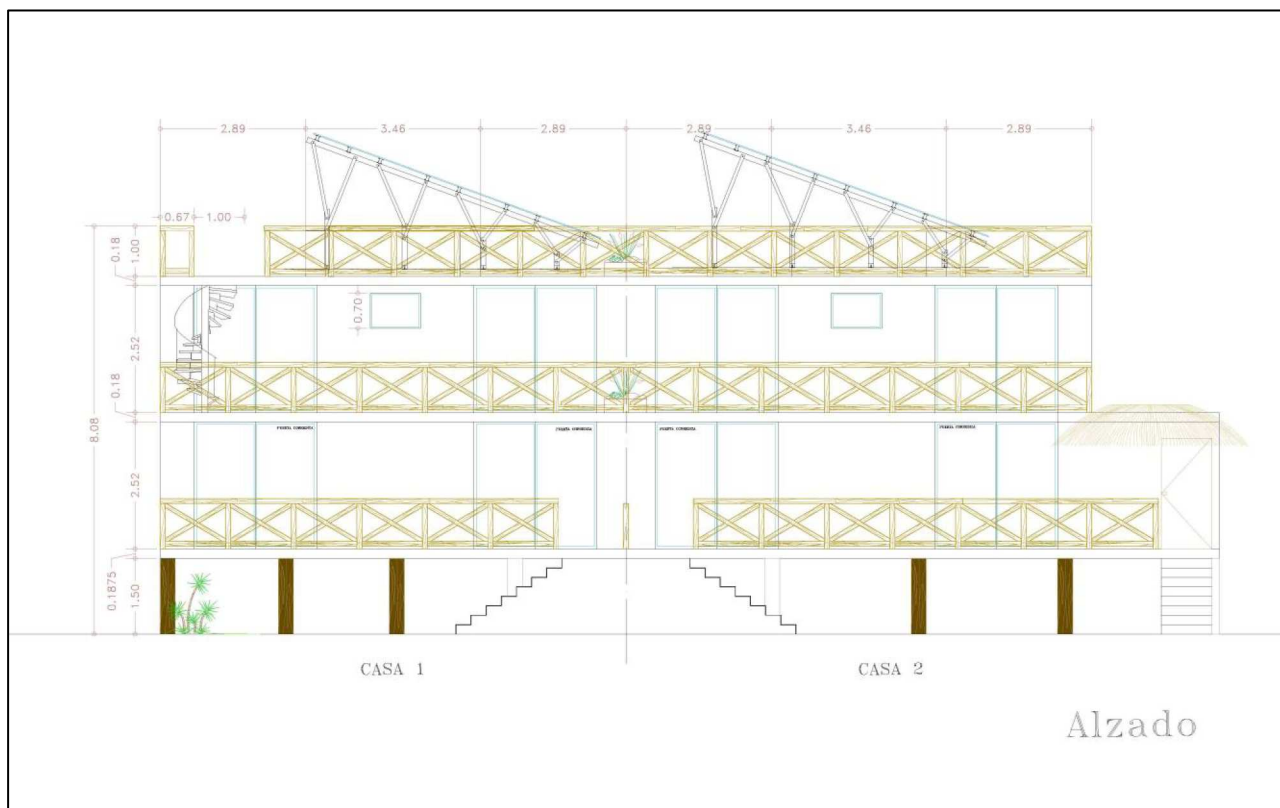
Fachada y alzado del proyecto arquitectónico de Villas Colibrí
